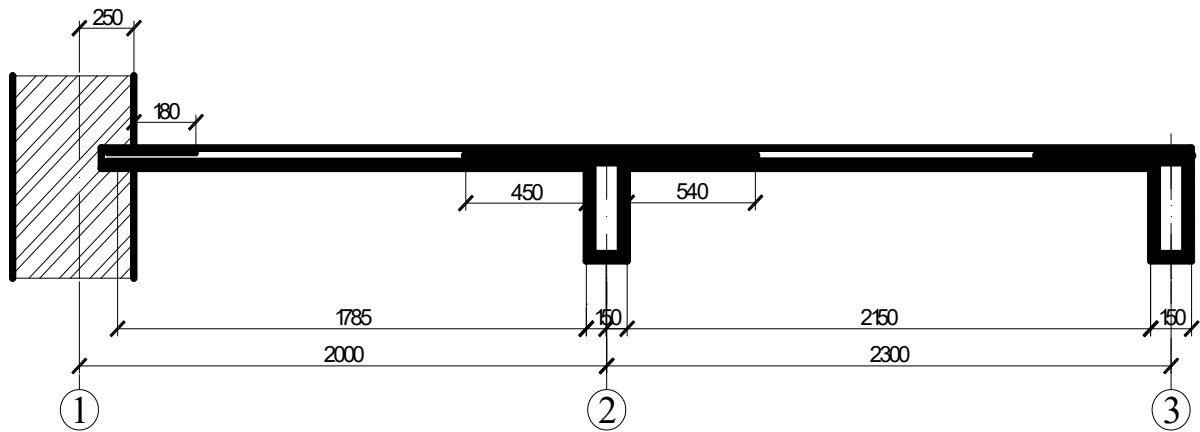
К определению расчетных пролетов монолитной плиты
